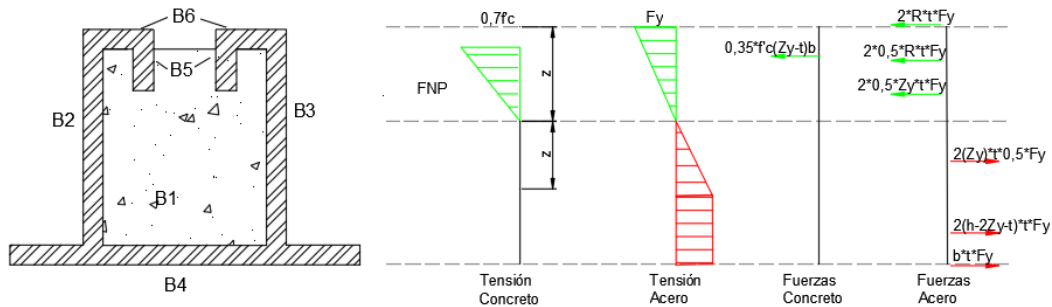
Distribución de tensiones y fuerzas en la Sección N°5 en el rango plástico.
